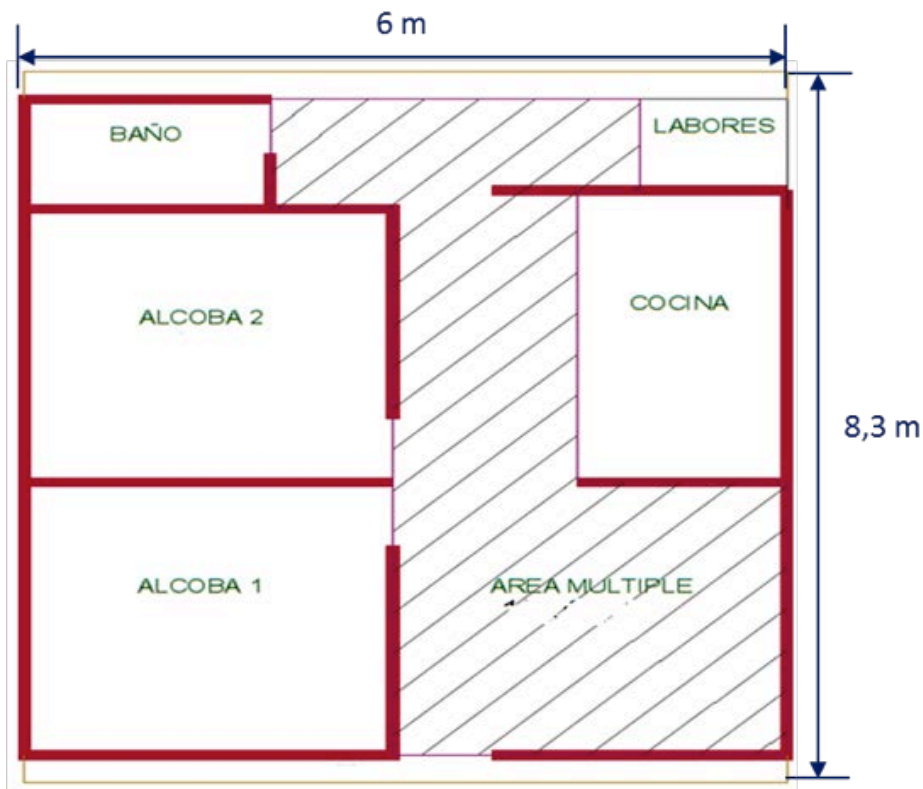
Plano arquitectónico en planta - vivienda tipo mampostería
